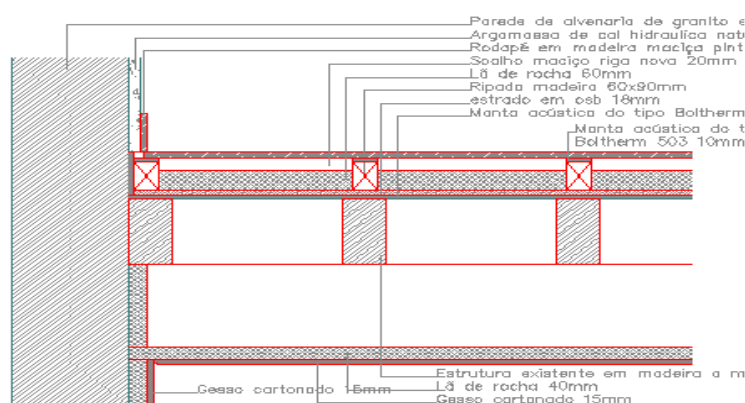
Pormenor do pavimento do piso das habitações das zonas secas.
